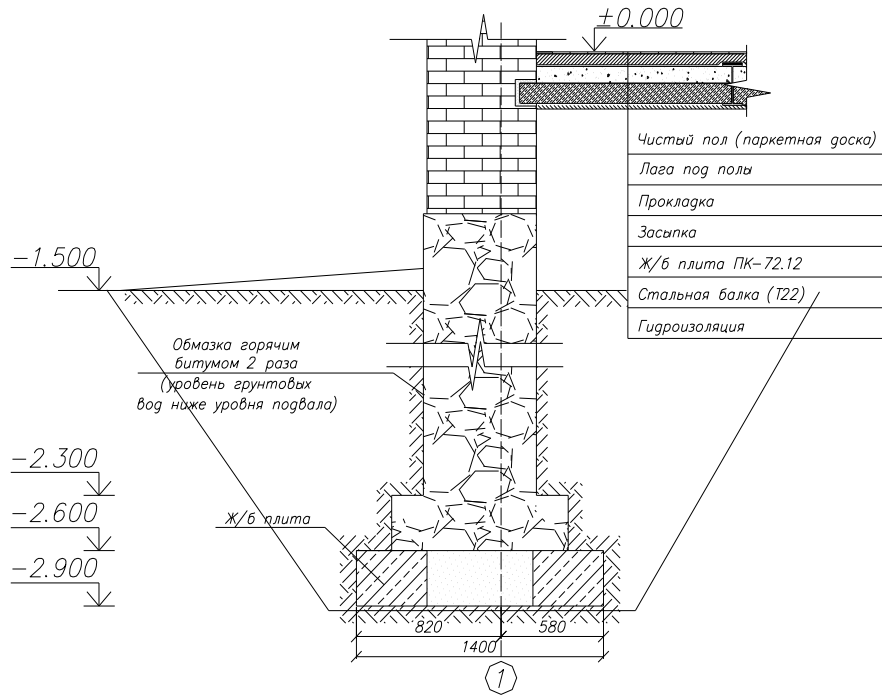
Усиление фундамента под наружную стену с использованием ж\б вставок и защита стены фундамента обмазочной гидроизоляцией.
